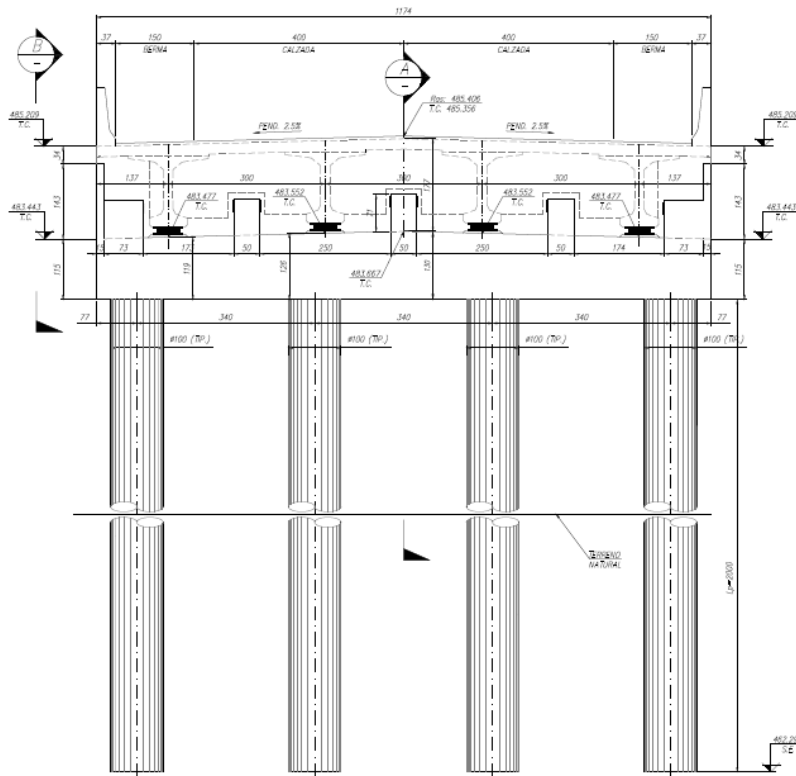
Elevación Tablero Puente San Pablo Antiguo. Fuente: Planos de Proyecto.
